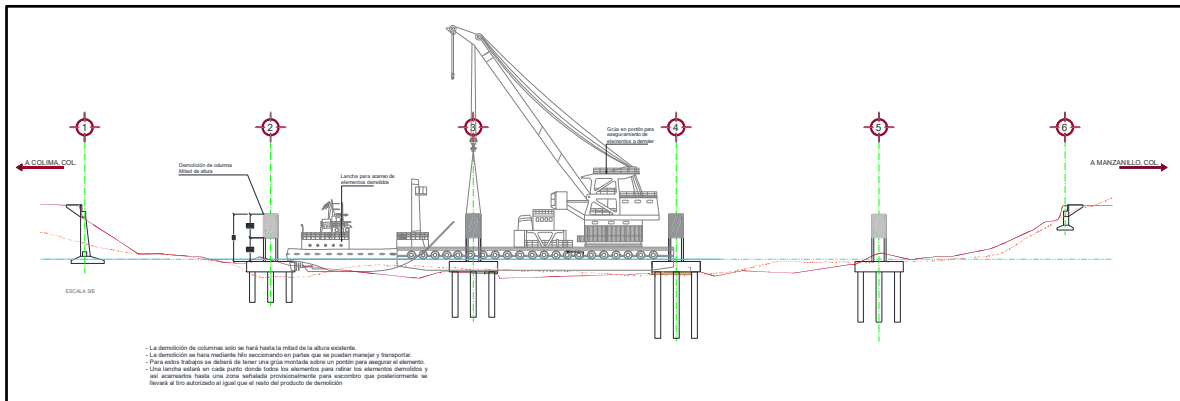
Demolición de columnas hasta la mitad de altura existente.
